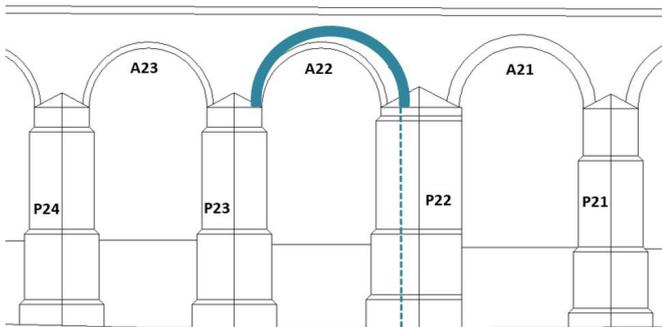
Replanteo del arco fallido sobre el pilar P22 visto desde su cara oeste. Fuente: elaboración propia.
